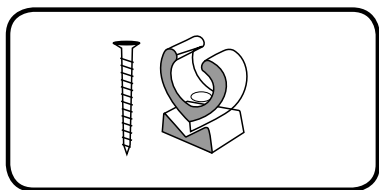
а - Цельнопластиковые опоры используются преимущественно для подвижного закрепления.
